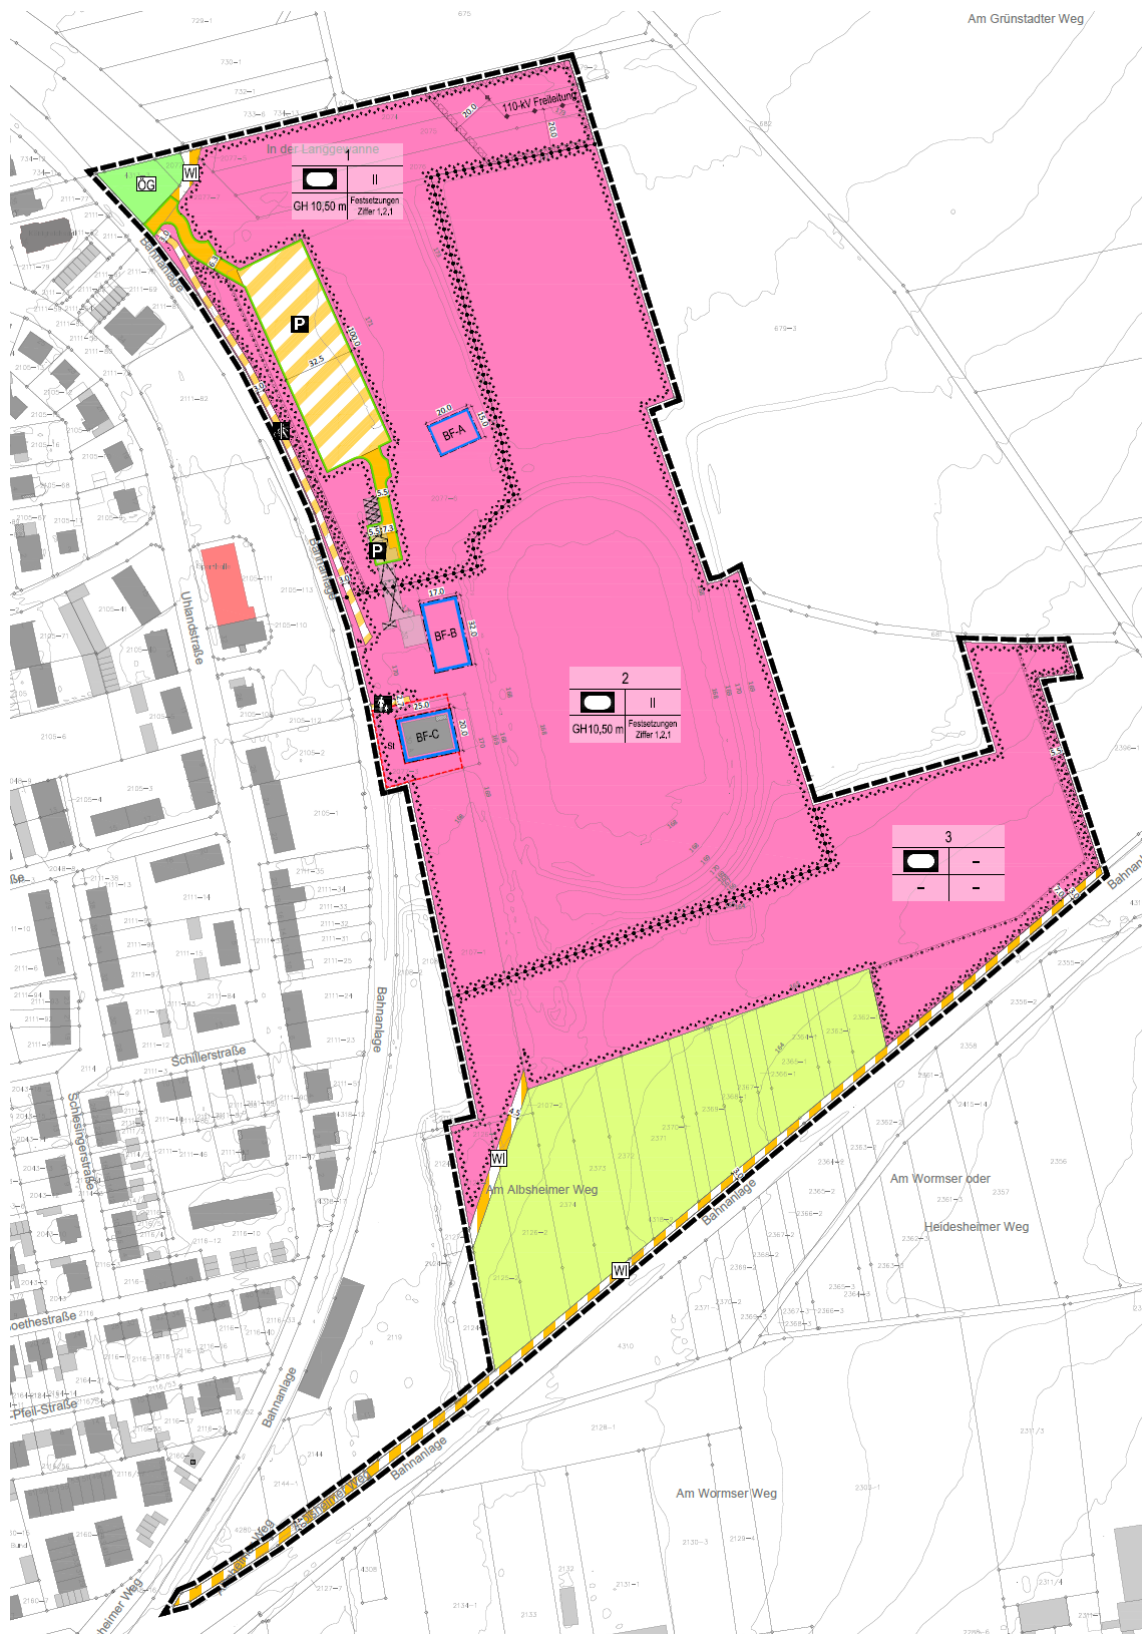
Entwurf des Bebauungsplans „Sportanlage Nordost – Änderung II“ (WSW & Partner, Stand: April 2026)
